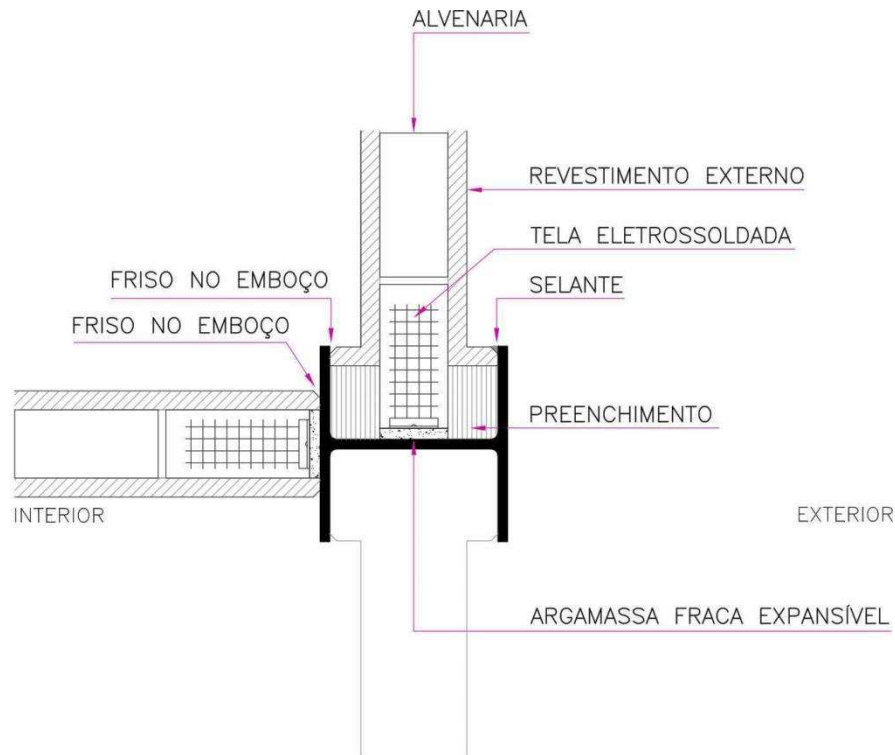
Detalhe em planta de uma alvenaria vinculada.
